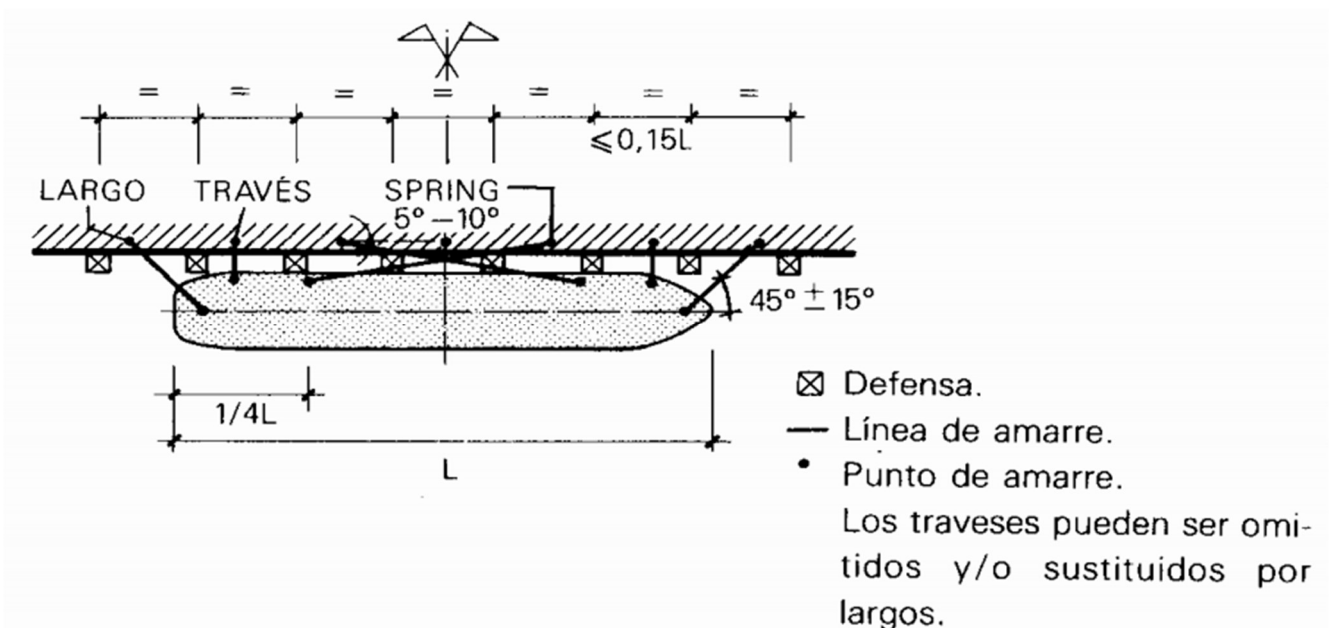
Layout de amarração – estrutura contínua – ROM 0.2-90
